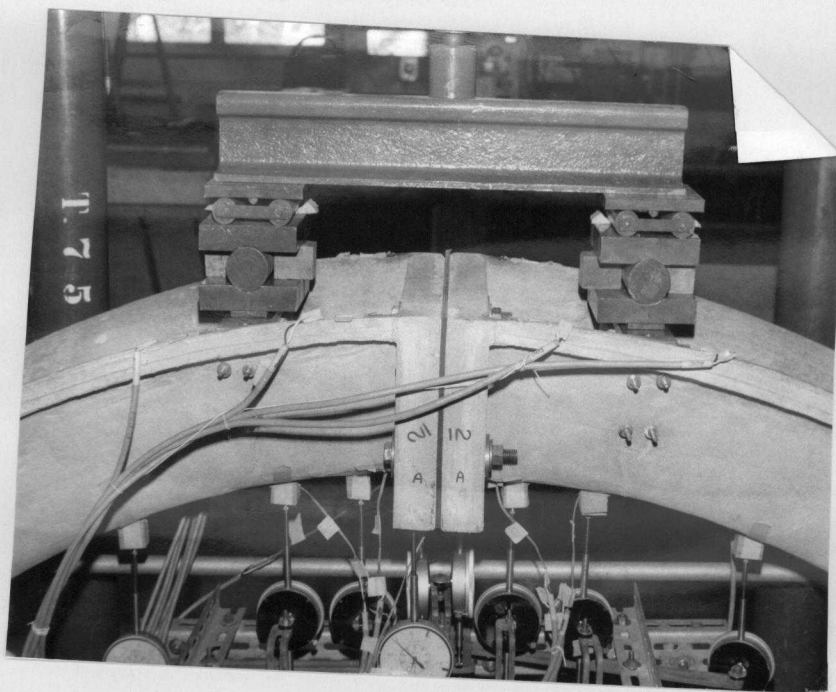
Emenda por parafuso - peça colocada para ser ensaiada.
